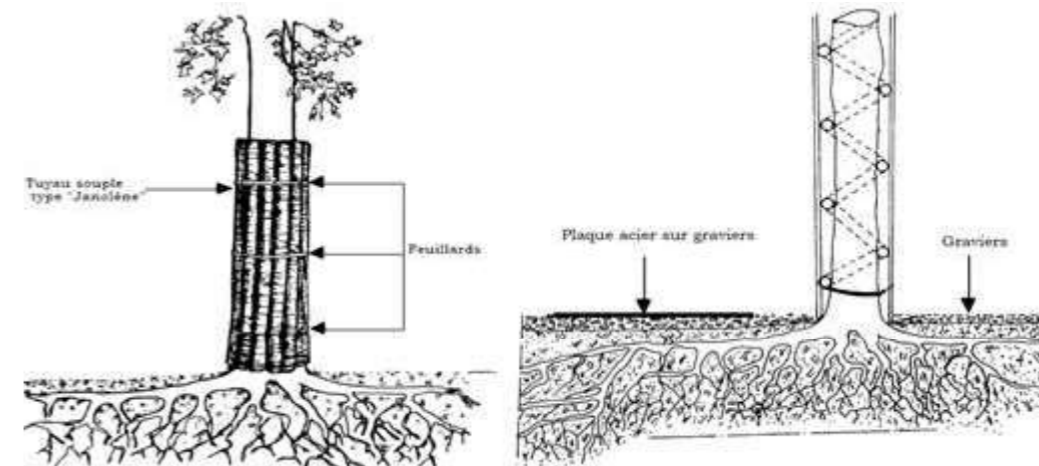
Schéma de principe d'une protection pour les arbres et leurs racines
